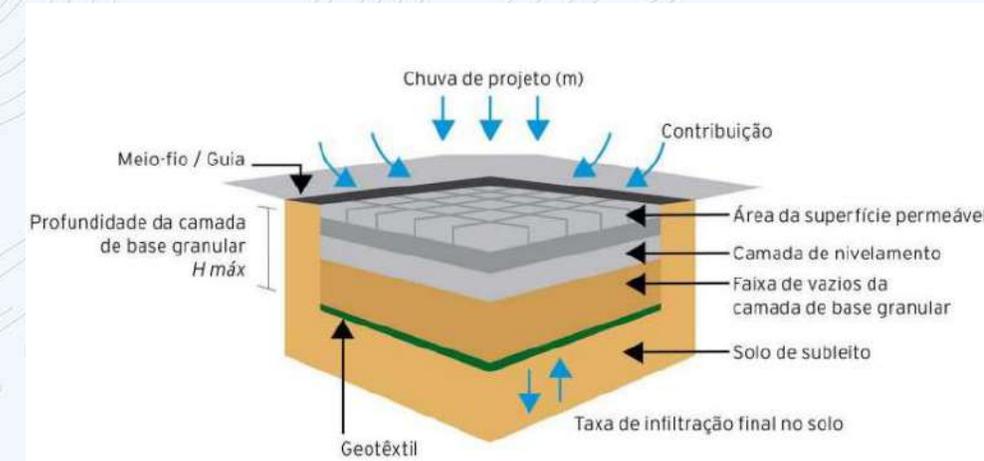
Corte típico de um pavimento permeável com revestimento de blocos intertravados de concreto.
